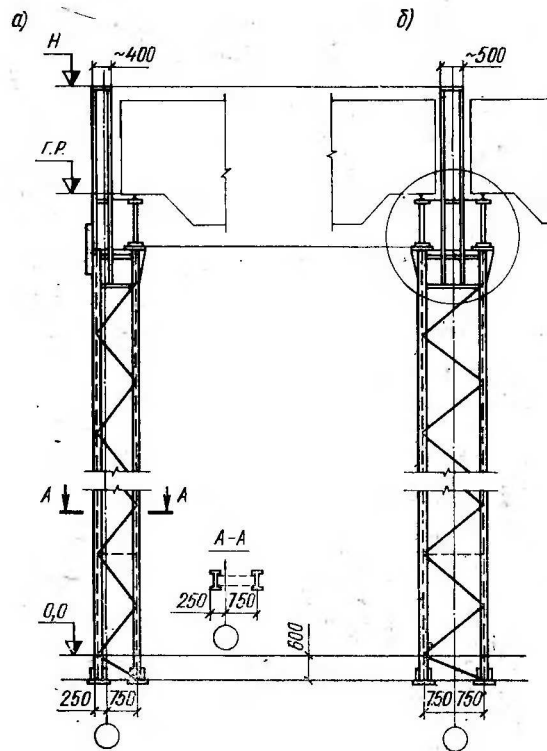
Колонны ступенчатого типа для крановых зданий без проходов вдоль подкрановых путей
